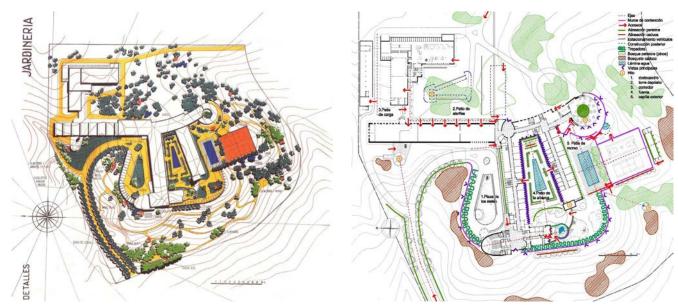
Plano de Jardinería, (*Informes de la Construcción*, 51,462). Análisis del jardín, elaborado por la autora (plano base, Archivo del ITCC, tubo I-86).
